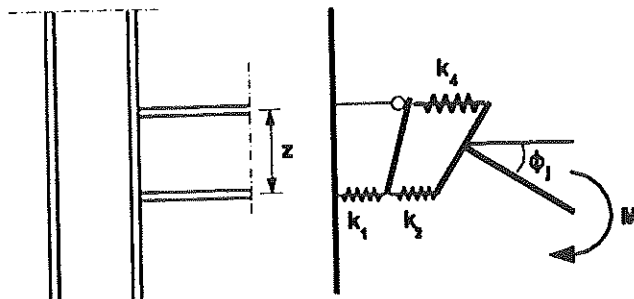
Modèle à ressorts pour assemblage soudé non raidi
